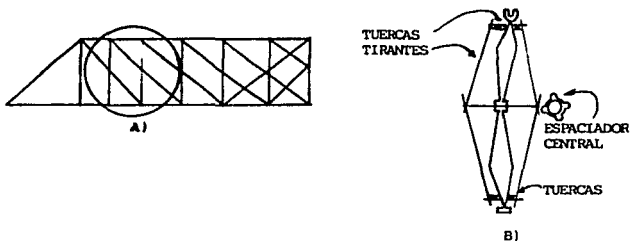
ARMADURA DE WHIPPLE; LA PROYECCION VERTICAL SE MUESTRA EN (A) Y EL DETALLE DE LAS VERTICALES DE HIERRO COLADO SE ILUSTRAN EN (B).
